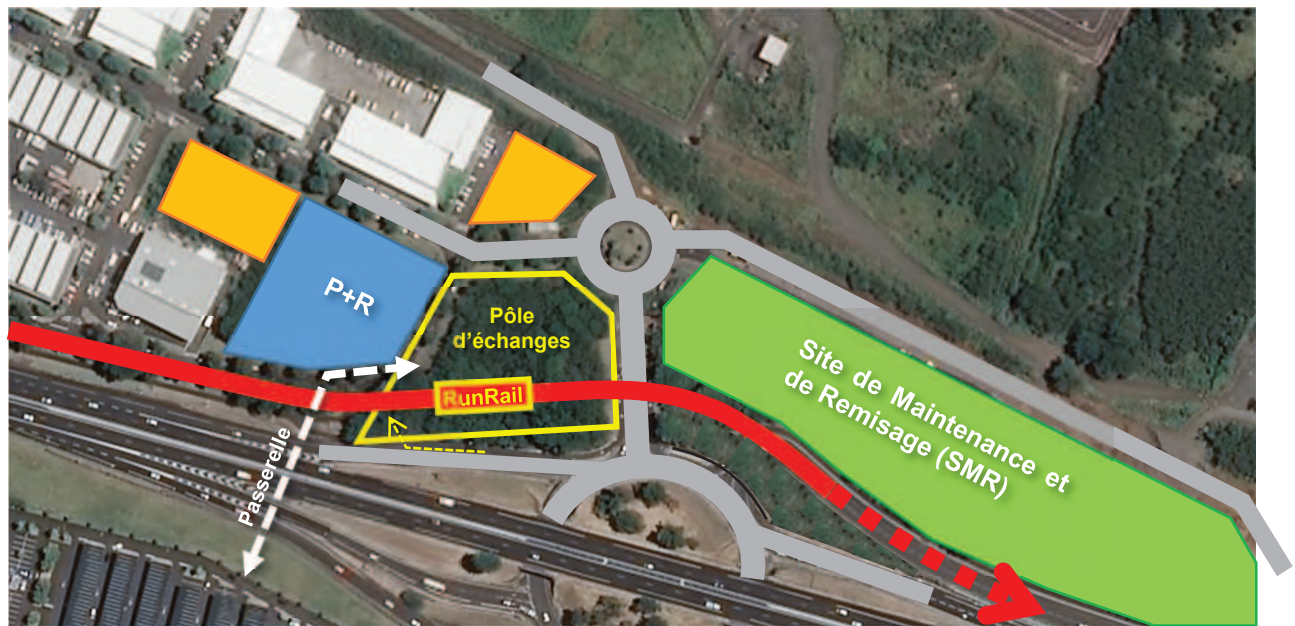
Plan de principe d'aménagement de la zone Duparc
